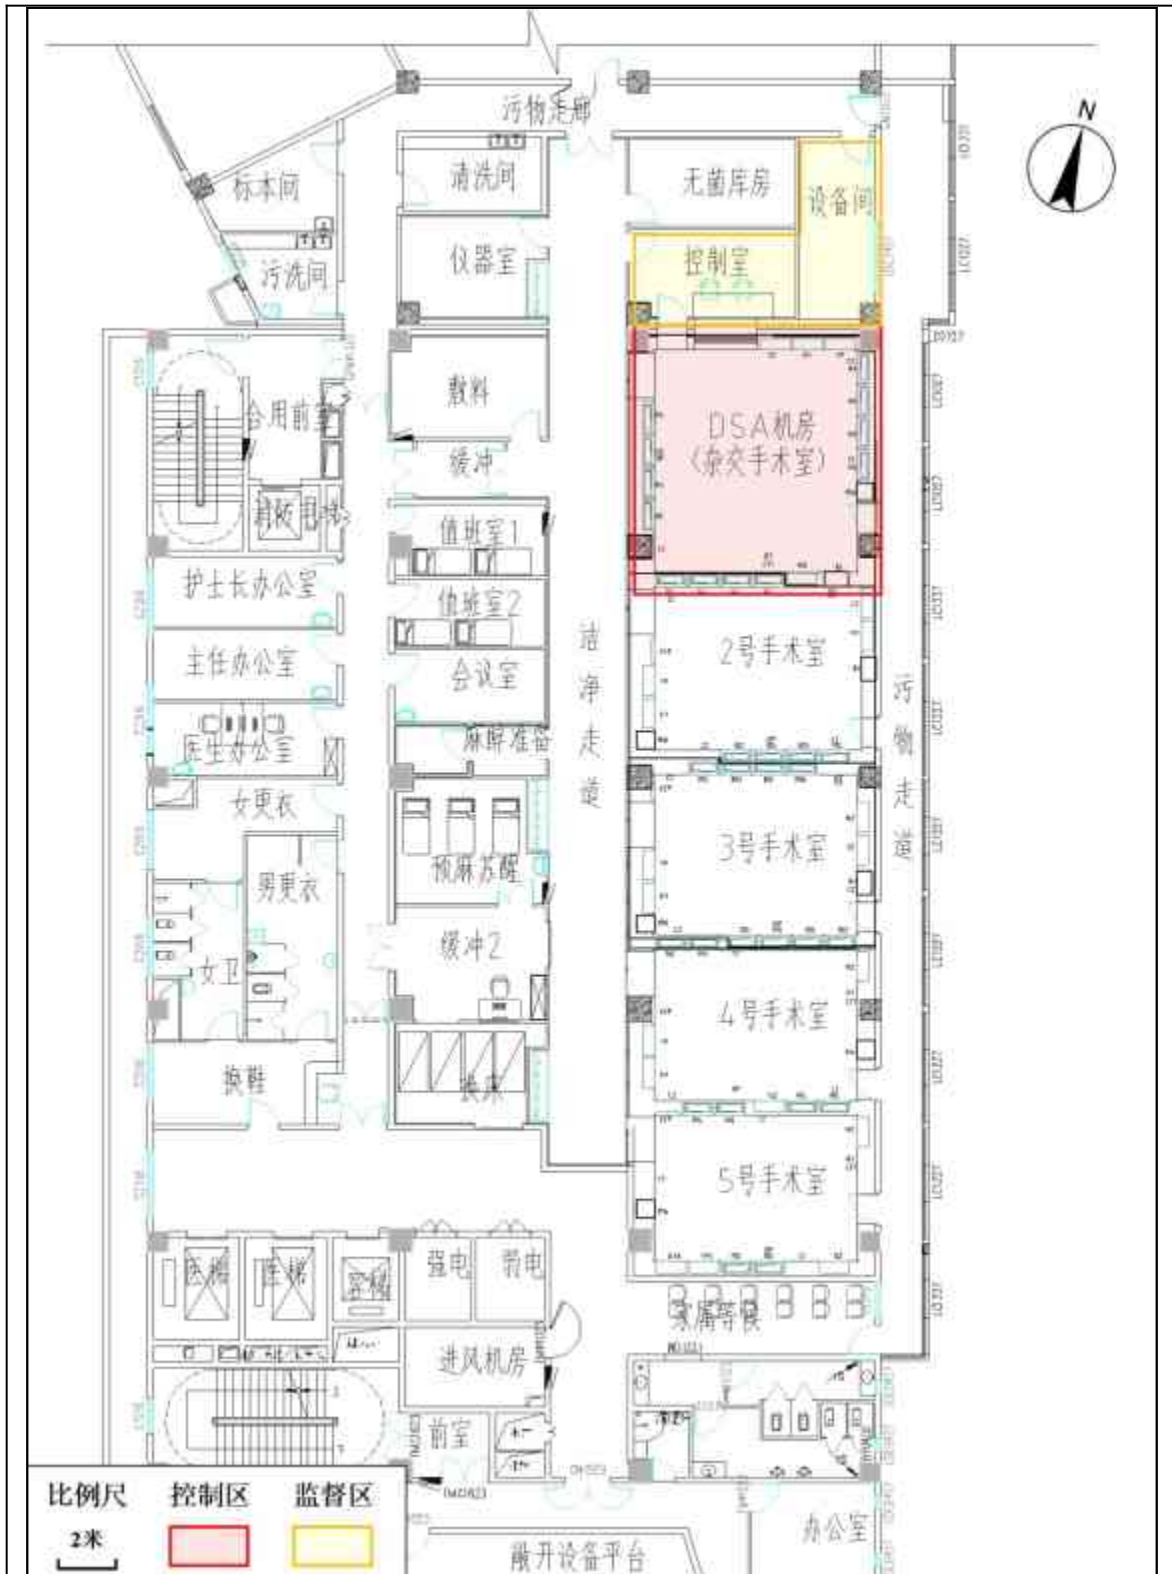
本部2号楼二层杂交手术室平面布置及分区示意图
